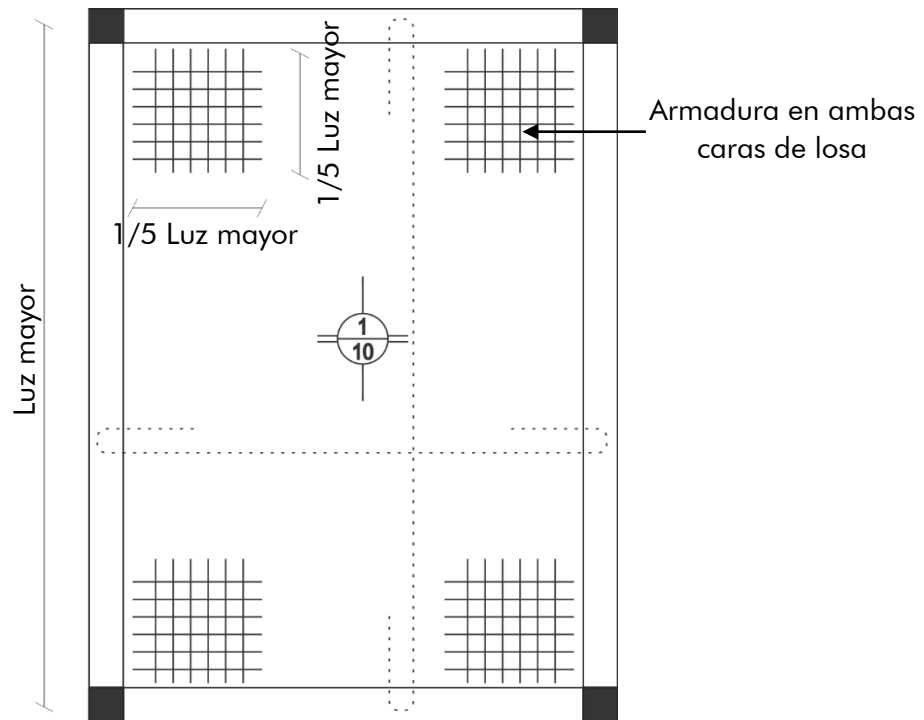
Armadura de esquinas para losas macizas en dos direcciones
